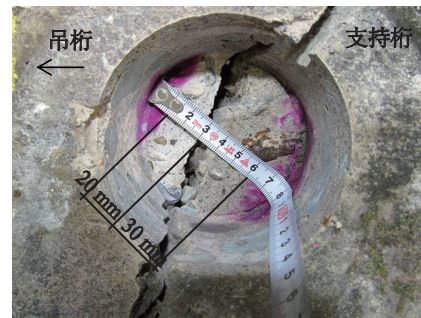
支持桁ひび割れ部コア削孔後
